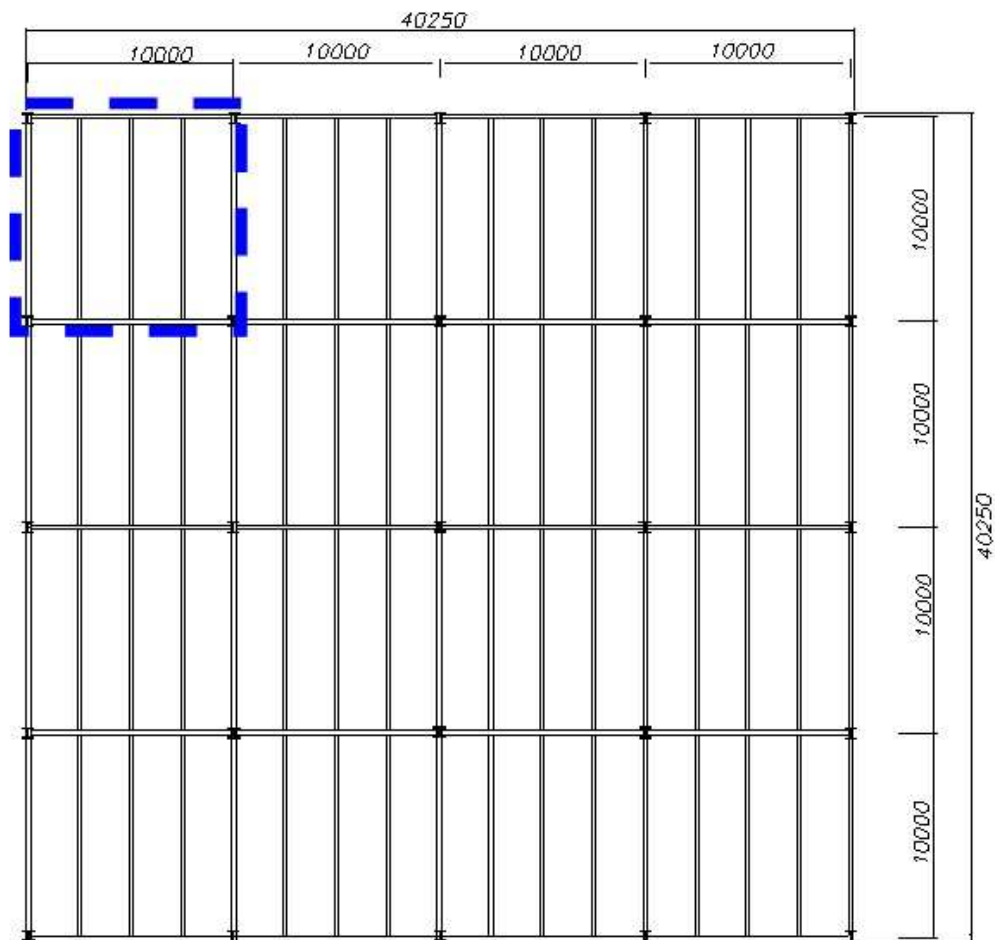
Planta baixa do piso misto (aço-concreto) investigado. Cotas em (mm) [6]
